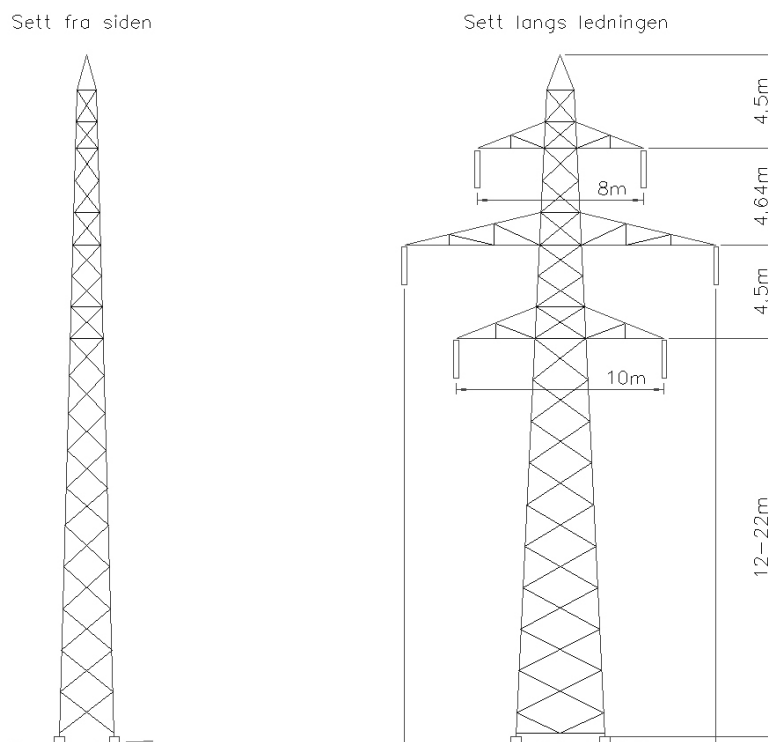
Eksempelskisse på 132 kV-tremast med planoppheng.
